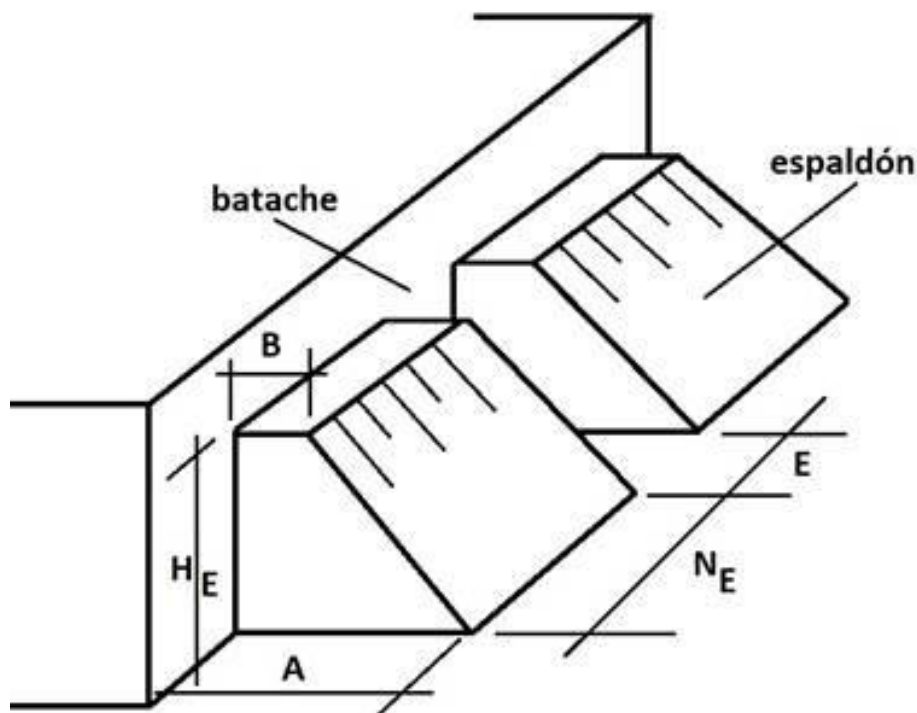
Detalle de las bermas (también denominadas bataches) en la ejecución de la zanja. Fuente: AECOM, 2024.
